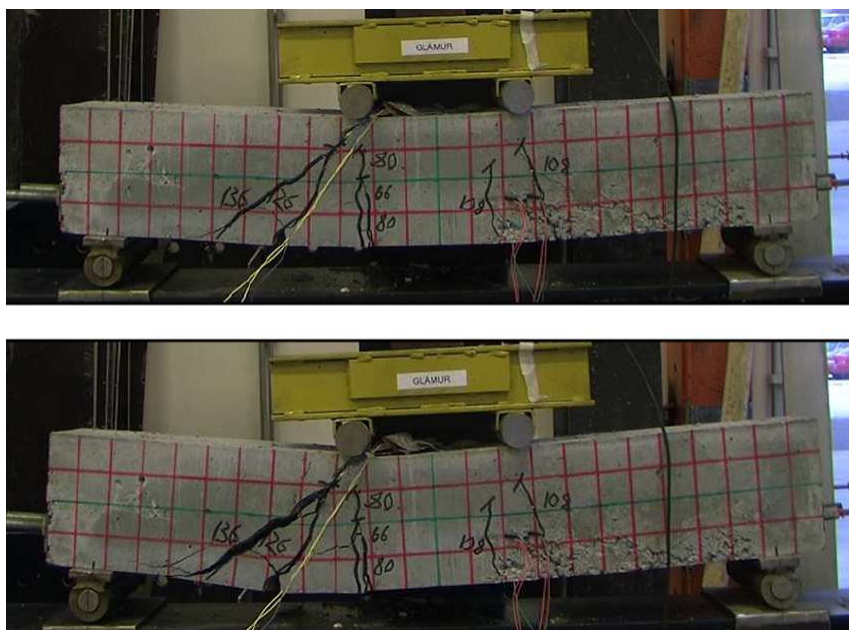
Comportamiento de fisuración en la viga al momento de la falla – Ensayo real ABS_A3 (Ásbjörnsson, 2013)
